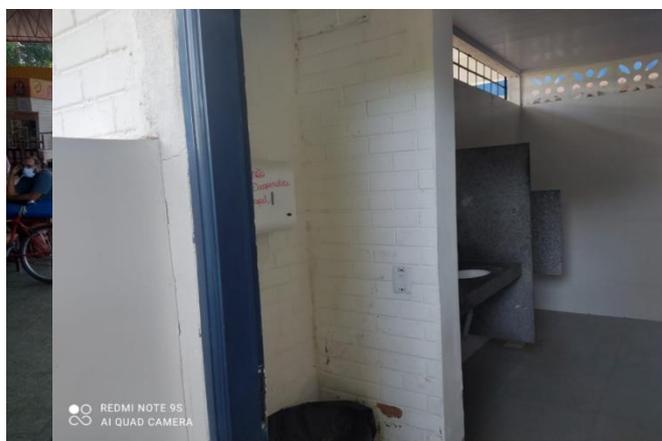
Vista interna do sanitário existente – Piso em bom estado de conservação, não necessita de intervenção em sua estrutura, apenas pintura interna.
